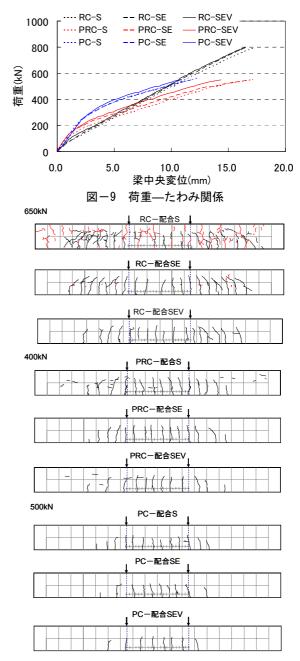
主鉄筋降伏前のひび割れ状況(RC の収縮ひび割れ:赤、PRC・PC の割裂ひび割れはスケッチせず)
